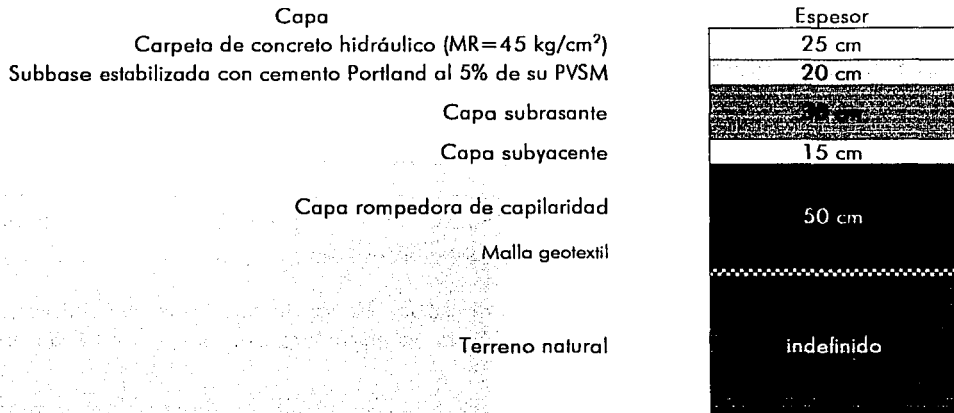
Sección de proyecto a construir para el tramo con capa rompedora de capilaridad.
